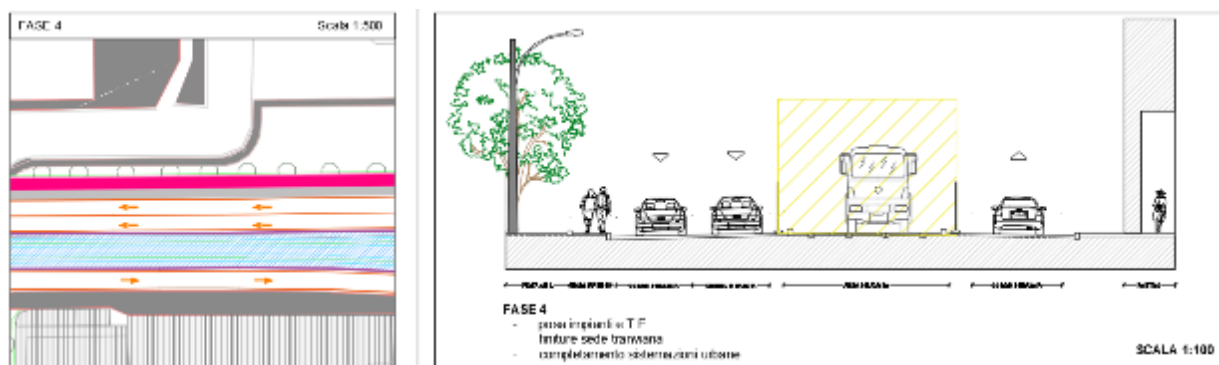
Tipologico cantiere con sede centrale Fase 4
